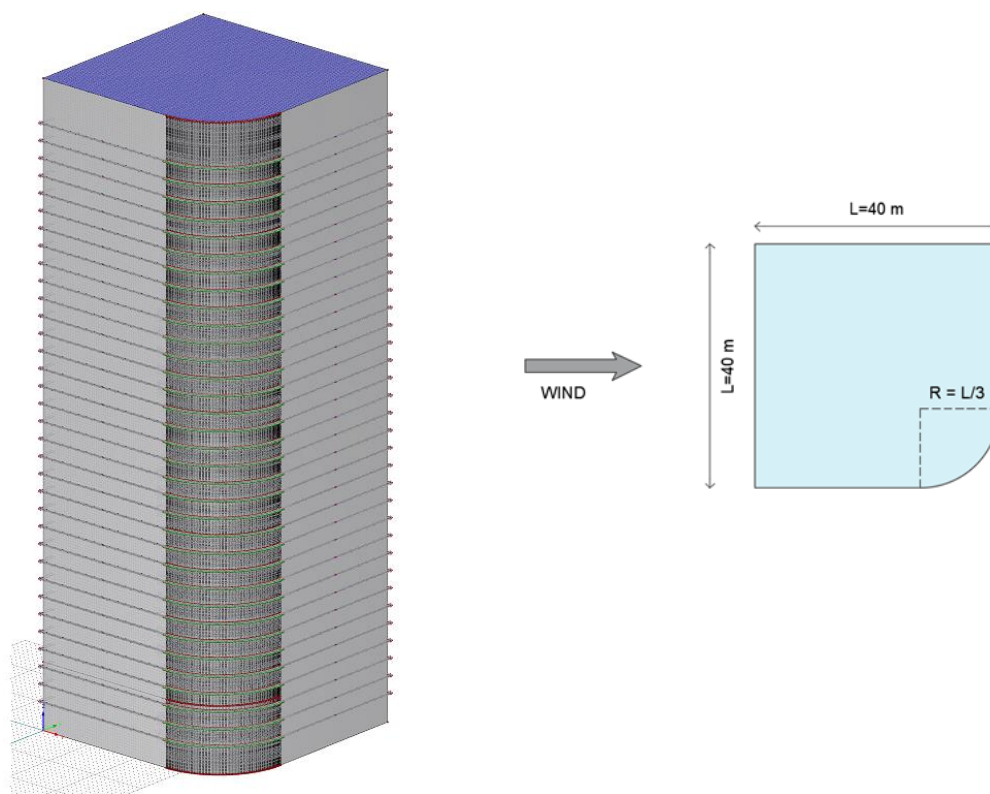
1: Vista assonometrica dell'edificio e configurazione in pianta, rispetto alla direzione del flusso del vento agente.
